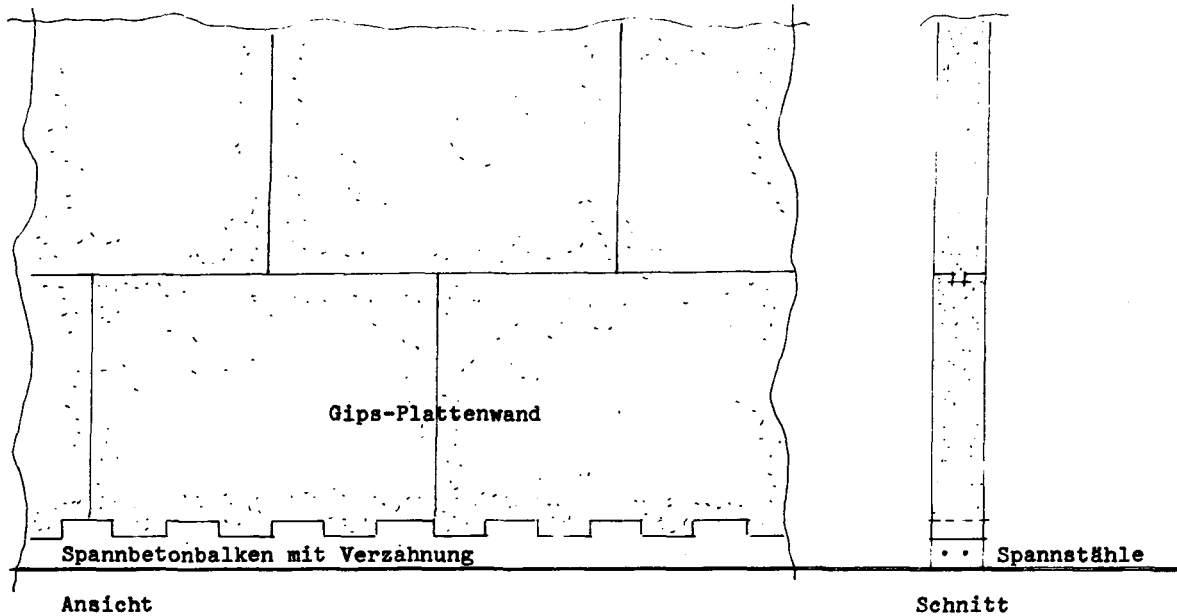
Konstruktionsvorschlag unter Verwendung eines Spannbetonbalkens
